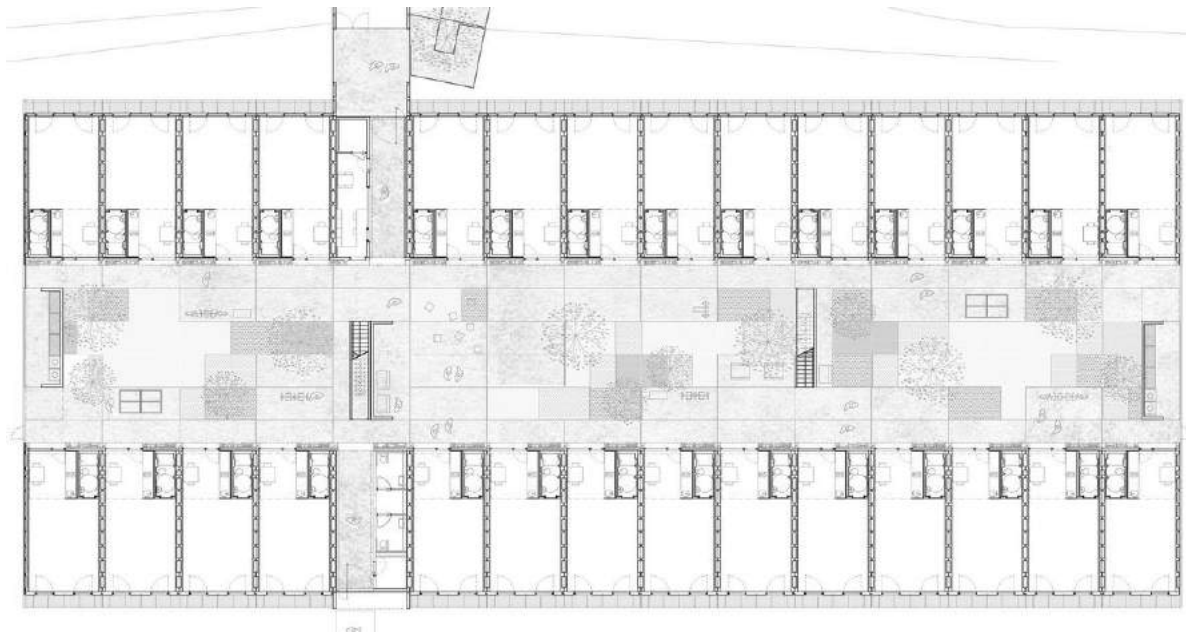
Grundriss Erdgeschoß Student Housing
